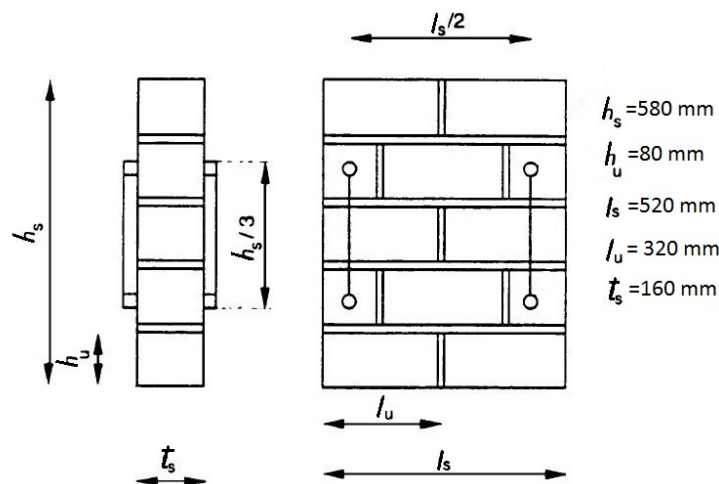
Disposición de los sensores de desplazamiento para un ensayo de pilas según la norma UNE-EN 1052-1.
